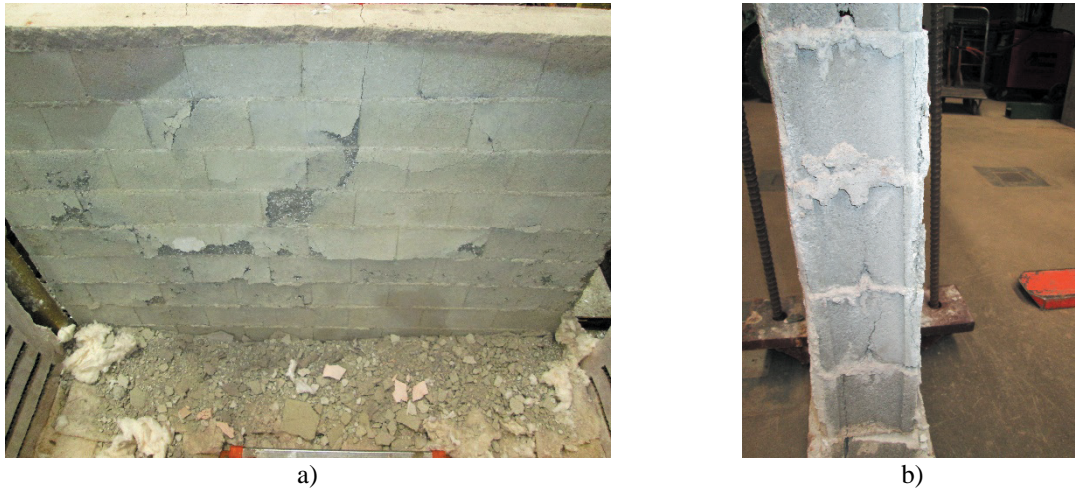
Provete 2 – a) Sinais de destacamento na face exposta ao incêndio; b) Fissuras verticais no meio do bloco e sinais de destacamento na face exposta (lado direito)
